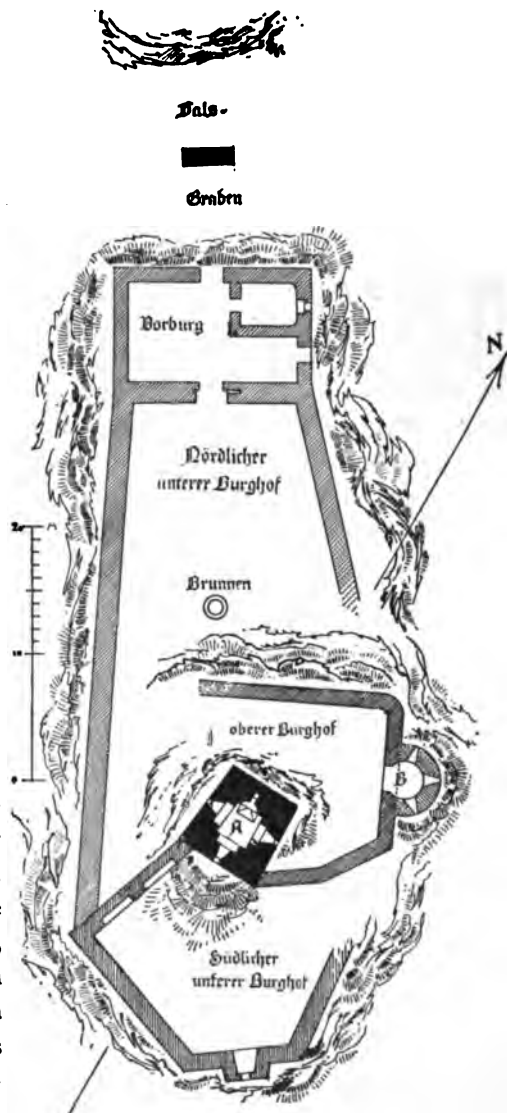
Ruine Rheinberg. Grundriss.
